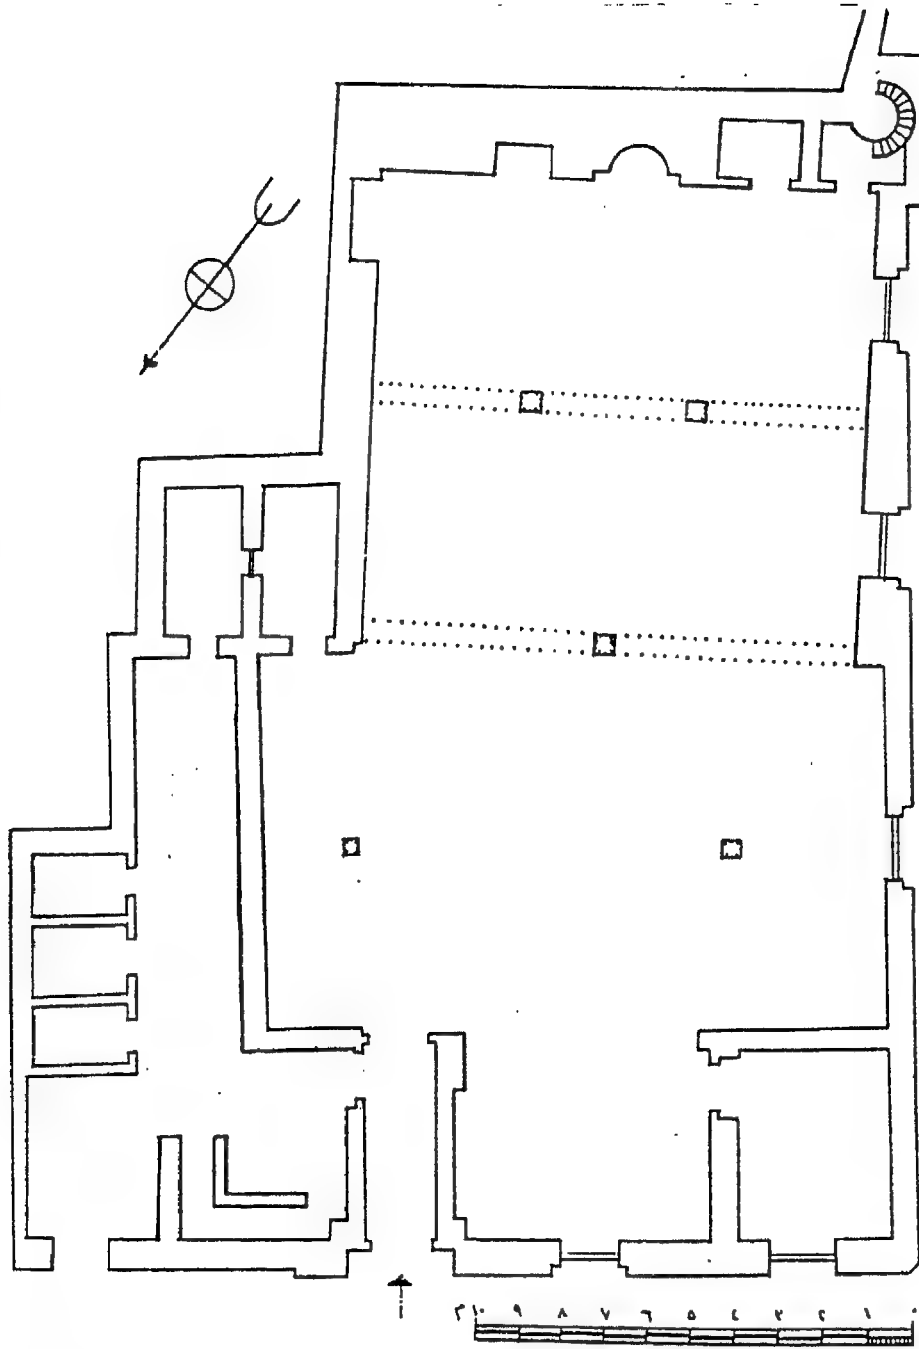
مسقط أفقي لجامع عقبة بن عامر بقرافة الإمام الليث بن سعد.
